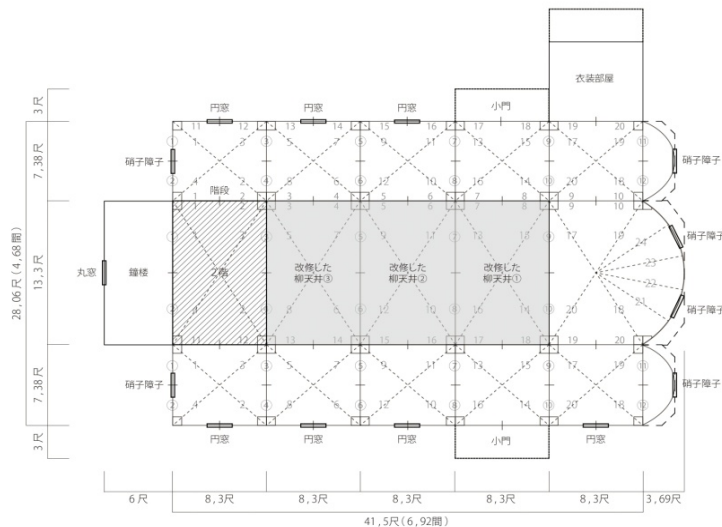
改修工事後の桐古天主堂 復元イメージ図 平面図
